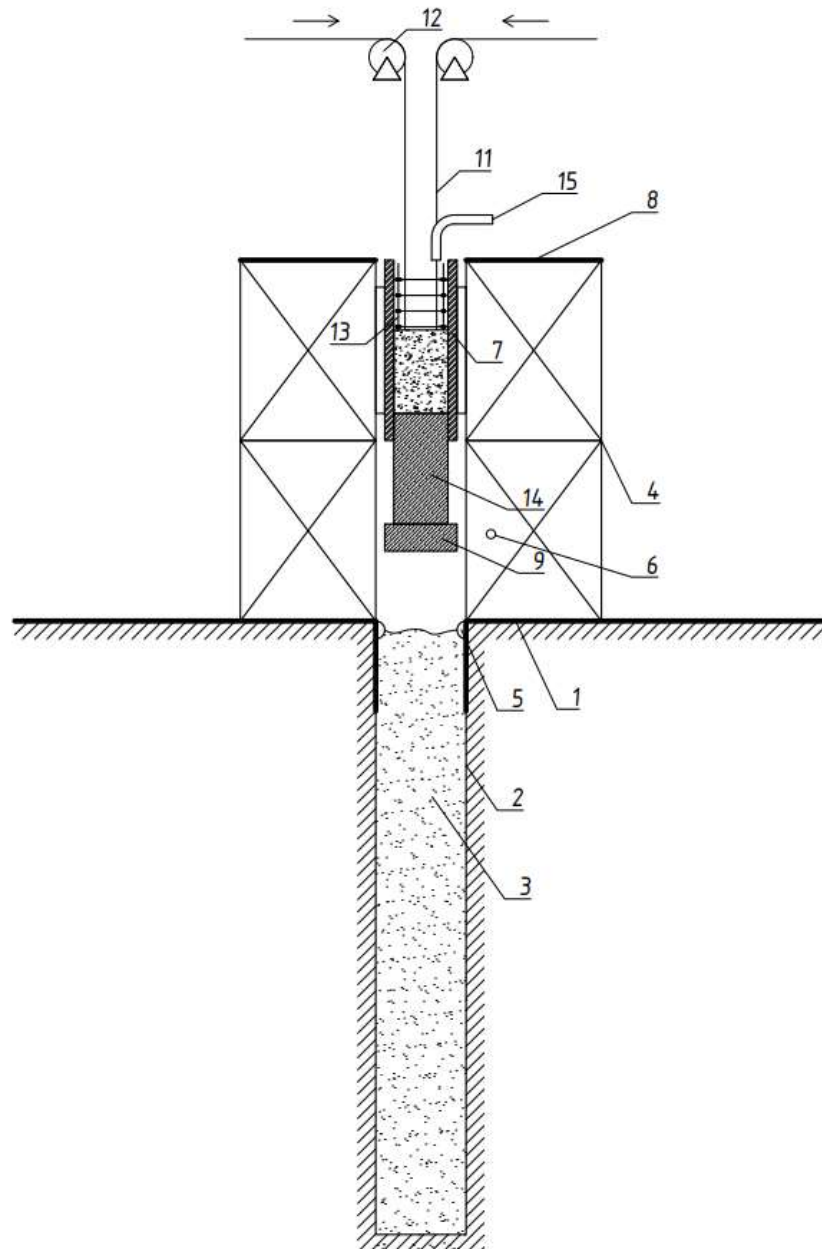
Безперервне бетонування та опускання конструкції
